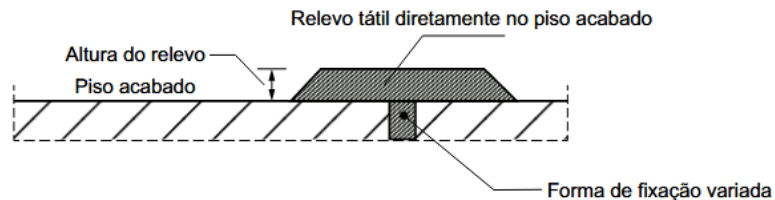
Detalhe do piso tátil sobreposto ao piso acabado
